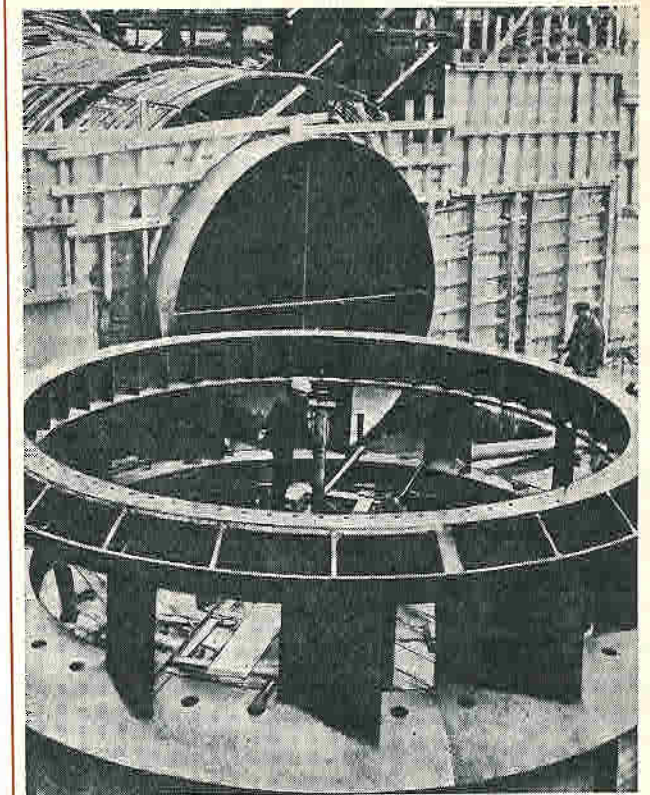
Проверка нивелиром высотного положения статора гидротурбины
